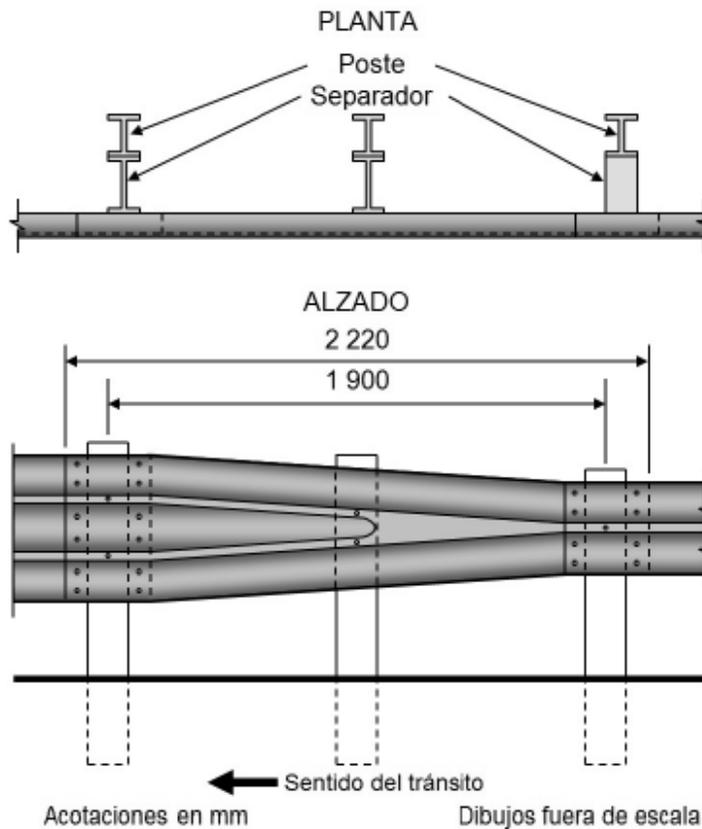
Sección de transición para unir vigas acanaladas de dos y de tres crestas
